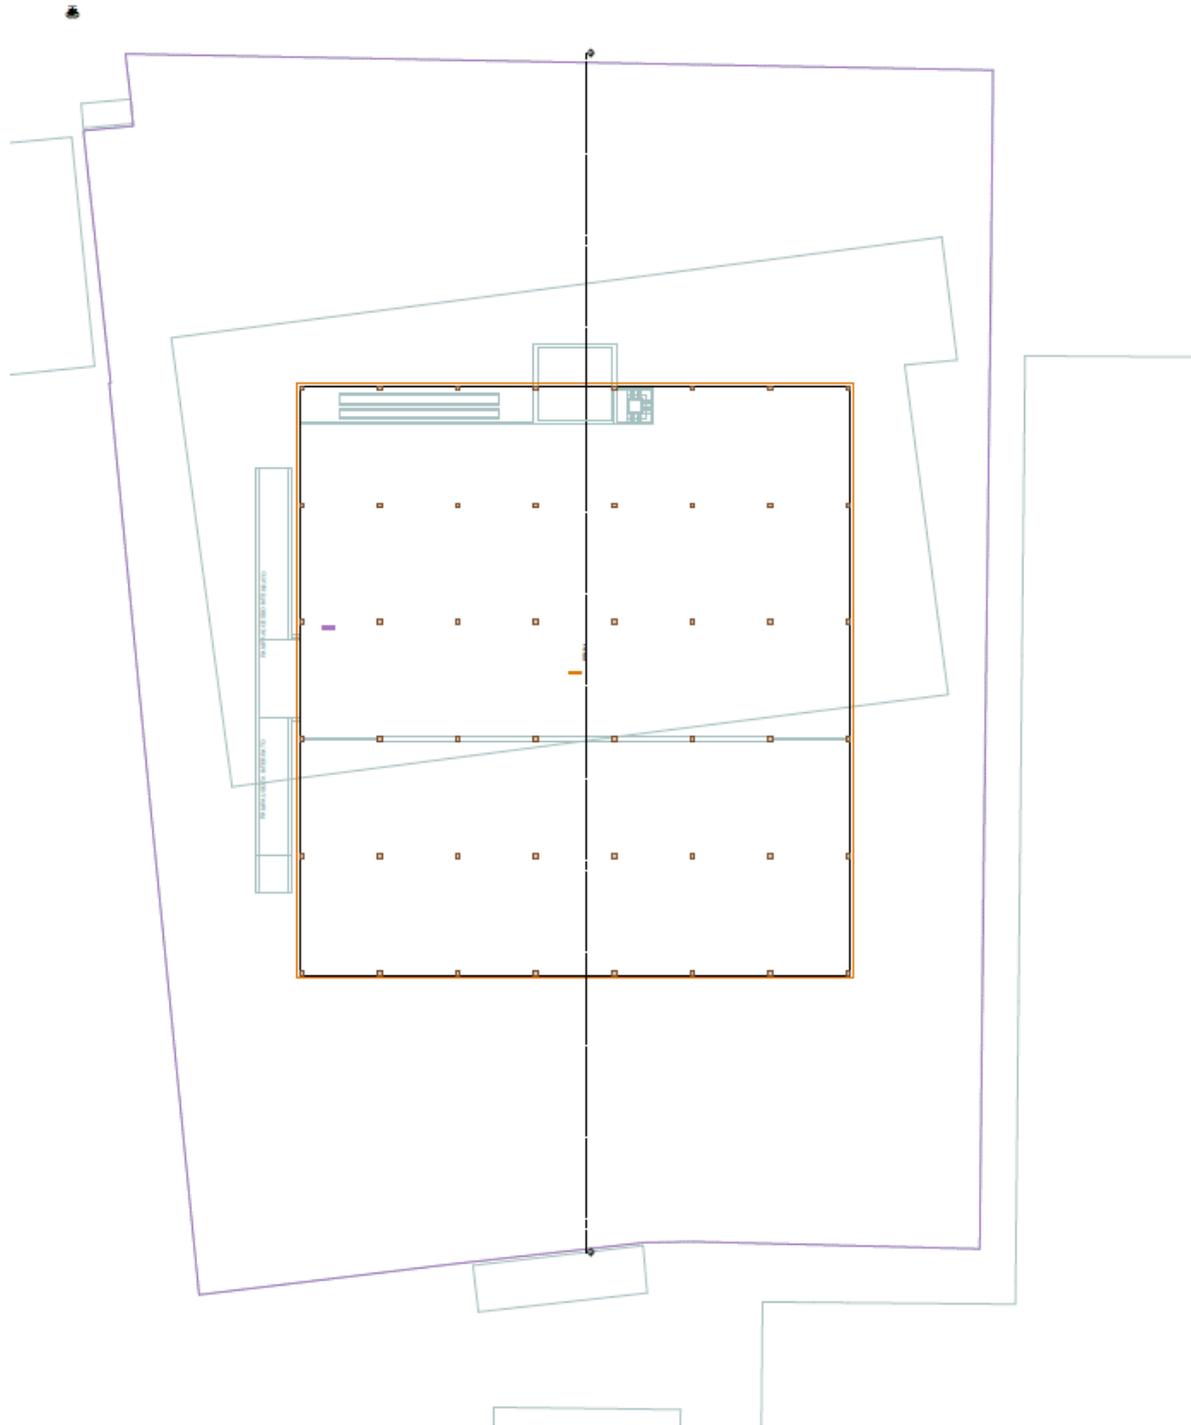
Vista planimetrica dell'area edificata sull'interrato
